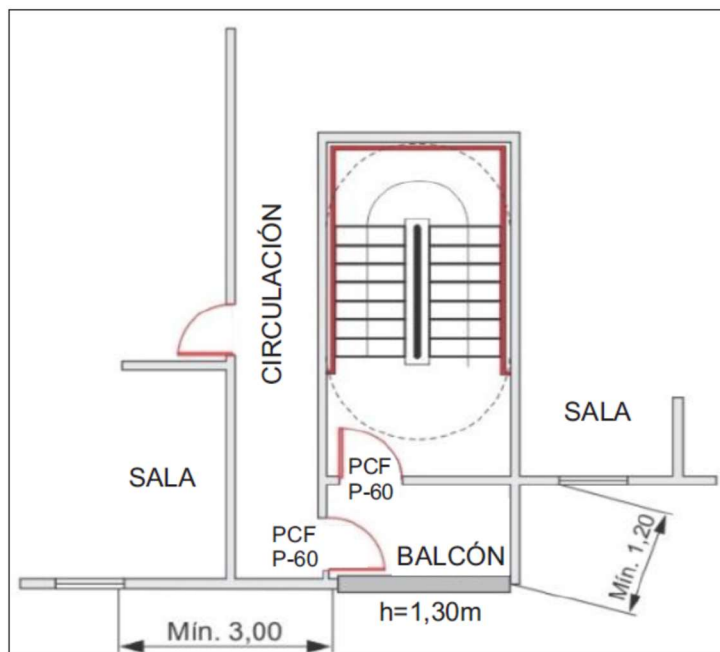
Escalera protegida del tipo PF ventilada por Balcón.
